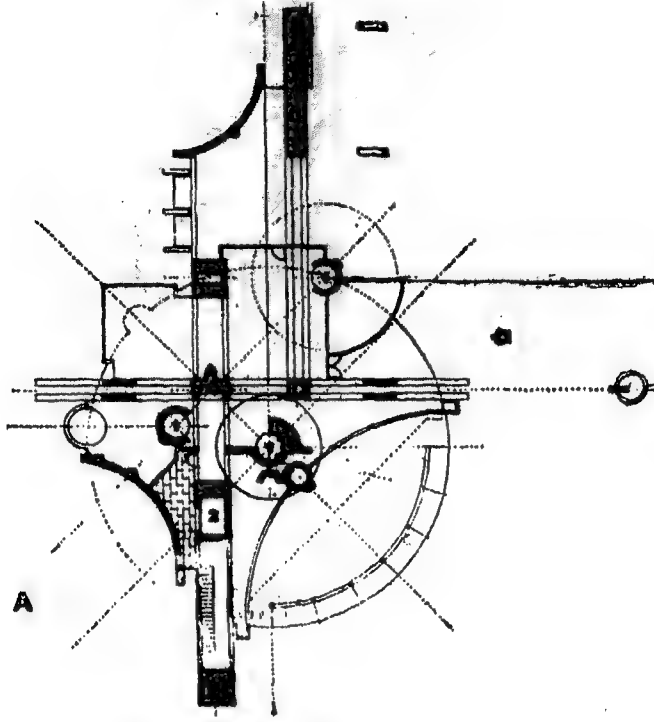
٣٧ - ٢ : واجهة المبنى.
